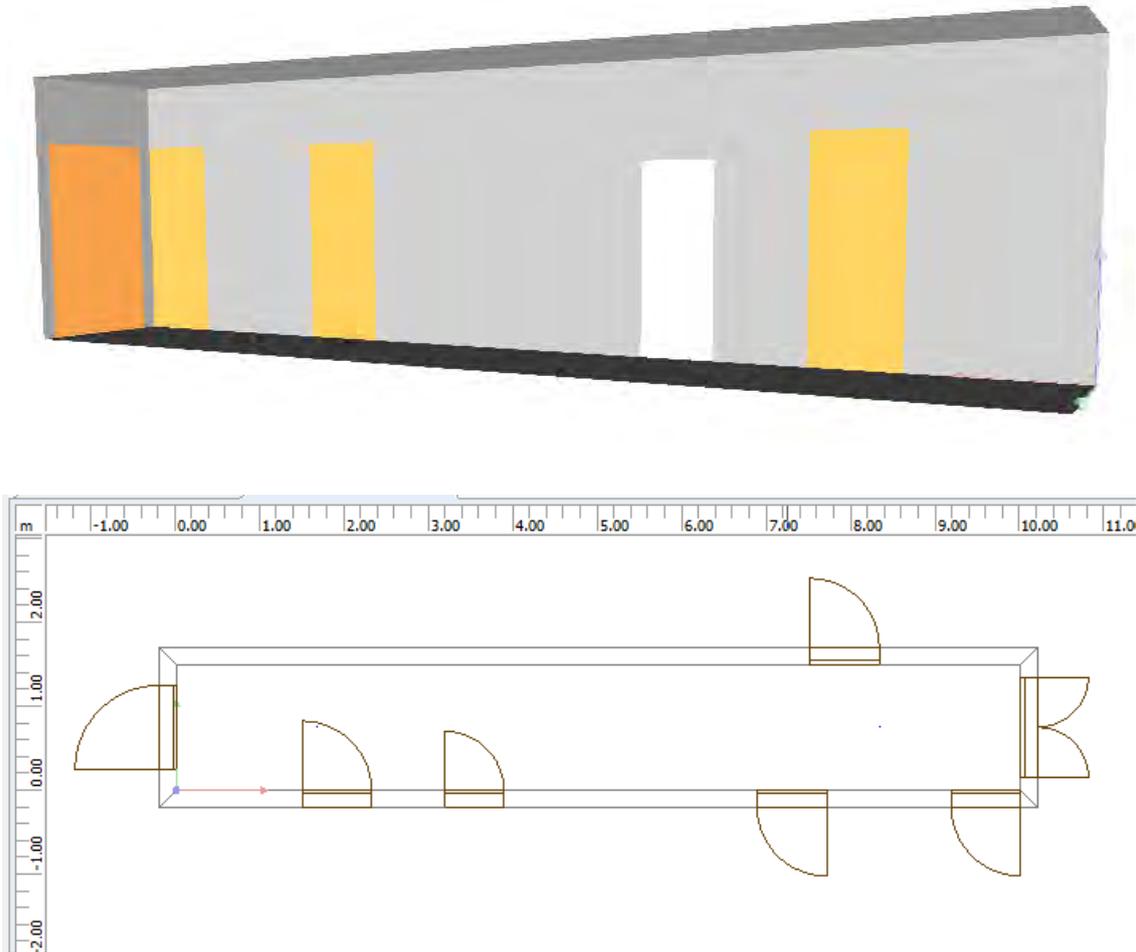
Sala principal de la planta de acondicionado en 3D y en planta.
